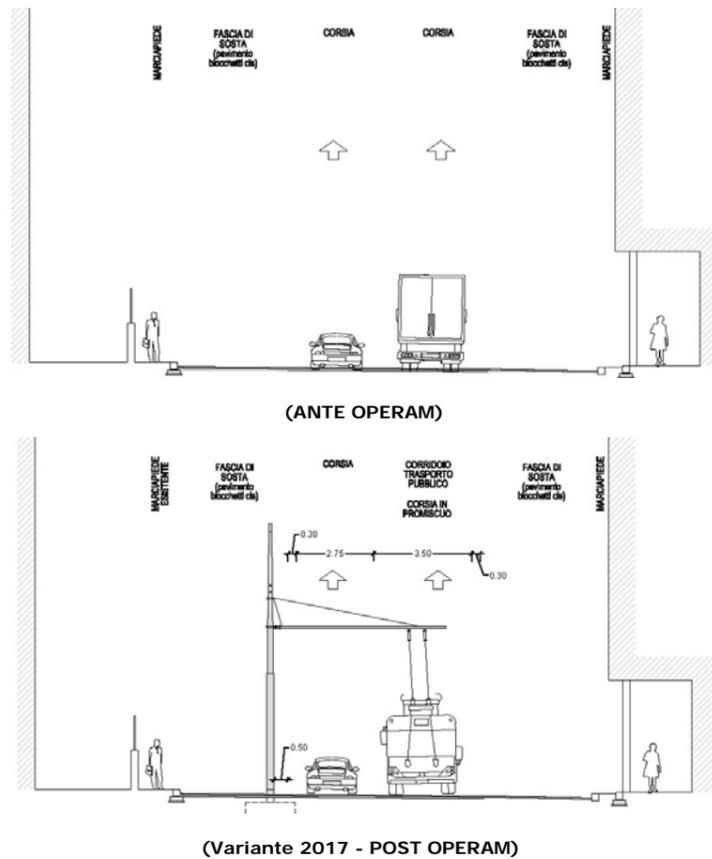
Sezione trasversale via C. Maestrini – Variante 2017
